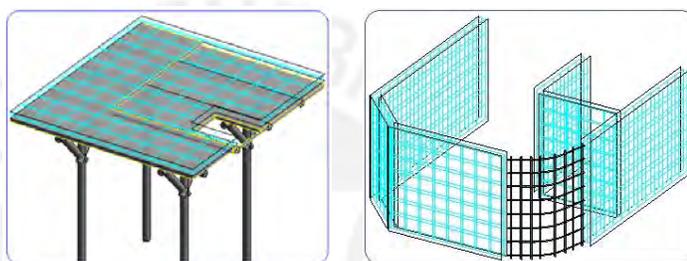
Colocación de acero en elementos verticales y horizontales.
